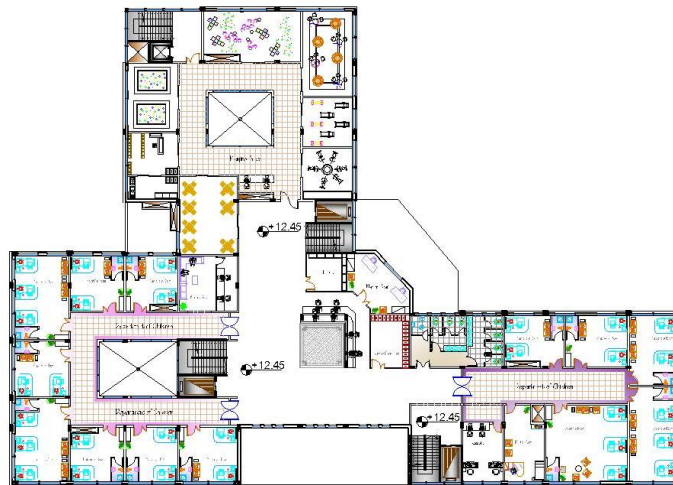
المسقط الأفقي للطابق الأول
